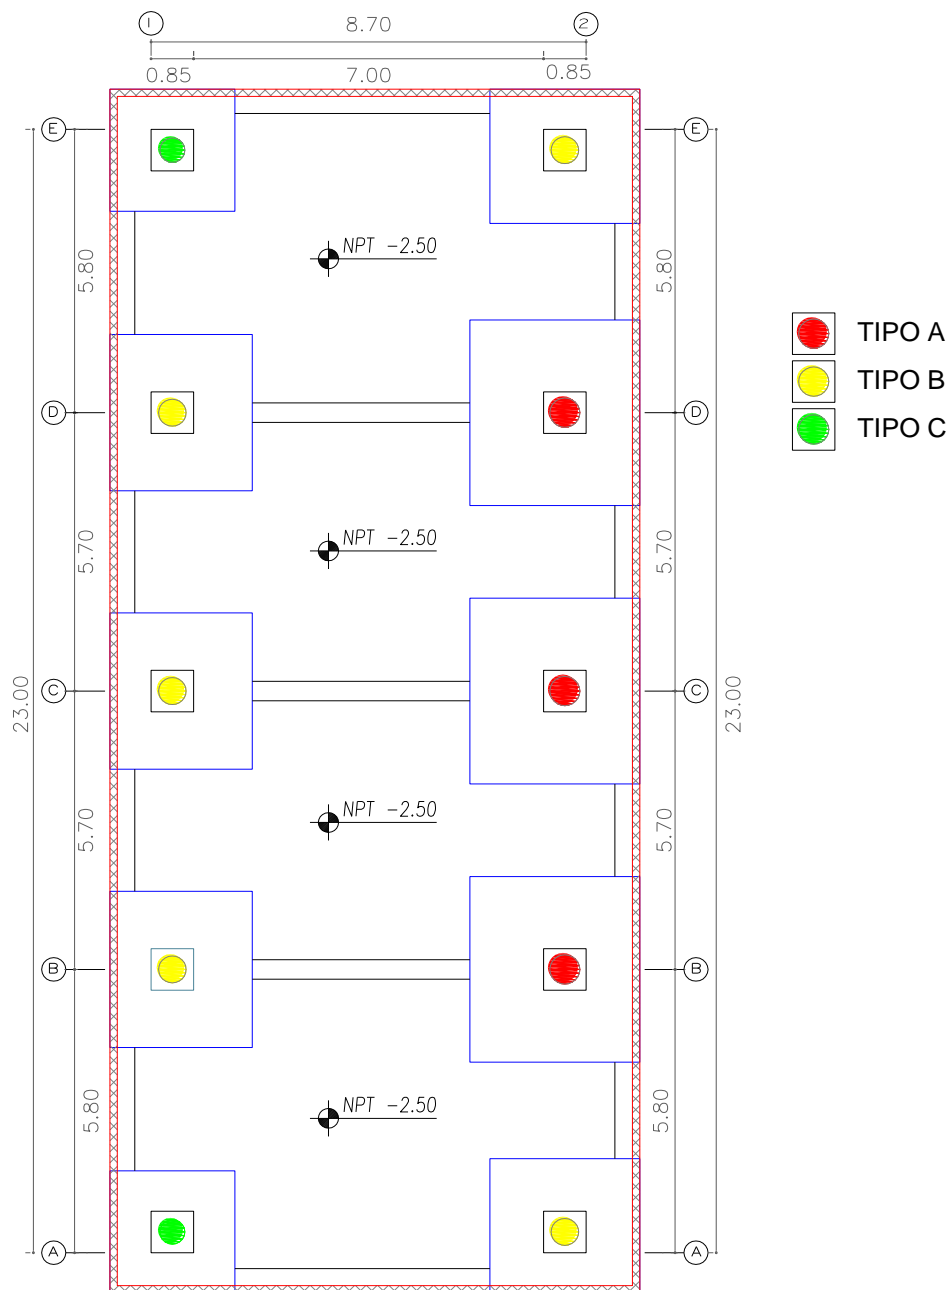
a. Distribución en planta de aisladores tipo A, B y C.
